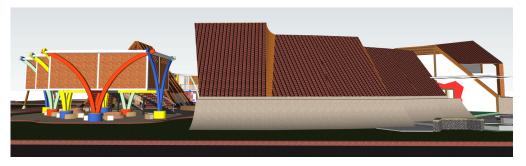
Perancangan Bentuk Massa Bangunan Keempat
